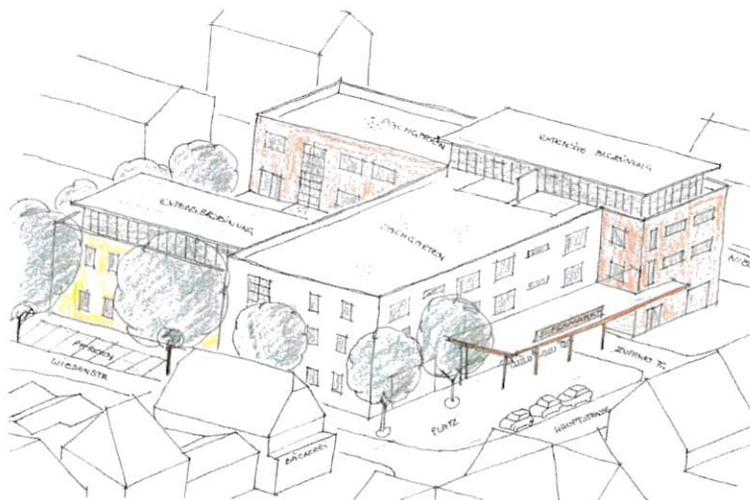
Skizze der geplanten Bebauung – Ansicht von Nord-Westen
